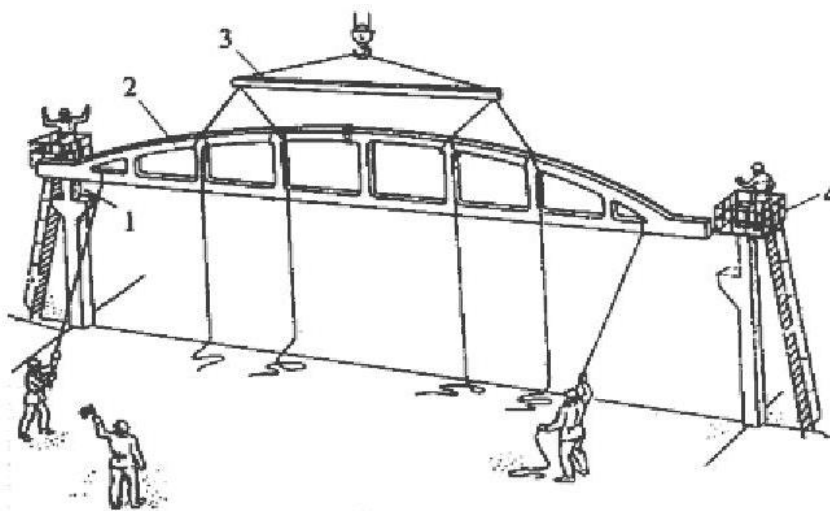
Схема монтажа фермы (1 – оттяжка, 2 – ферма, 3 – траверса, монтажная лестница)
